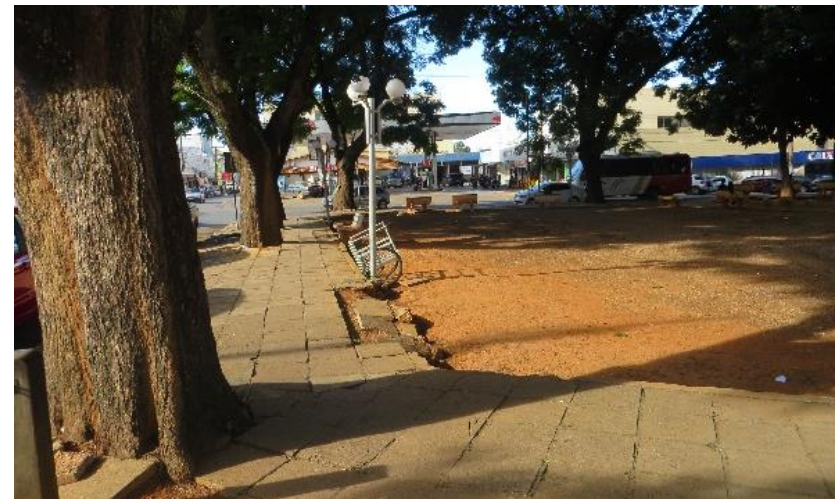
Calçadas e bancos quebrados, árvores plantada ao centro da calçada, sem gola ou canteiro. Fonte: Foto da autora, 2016.
